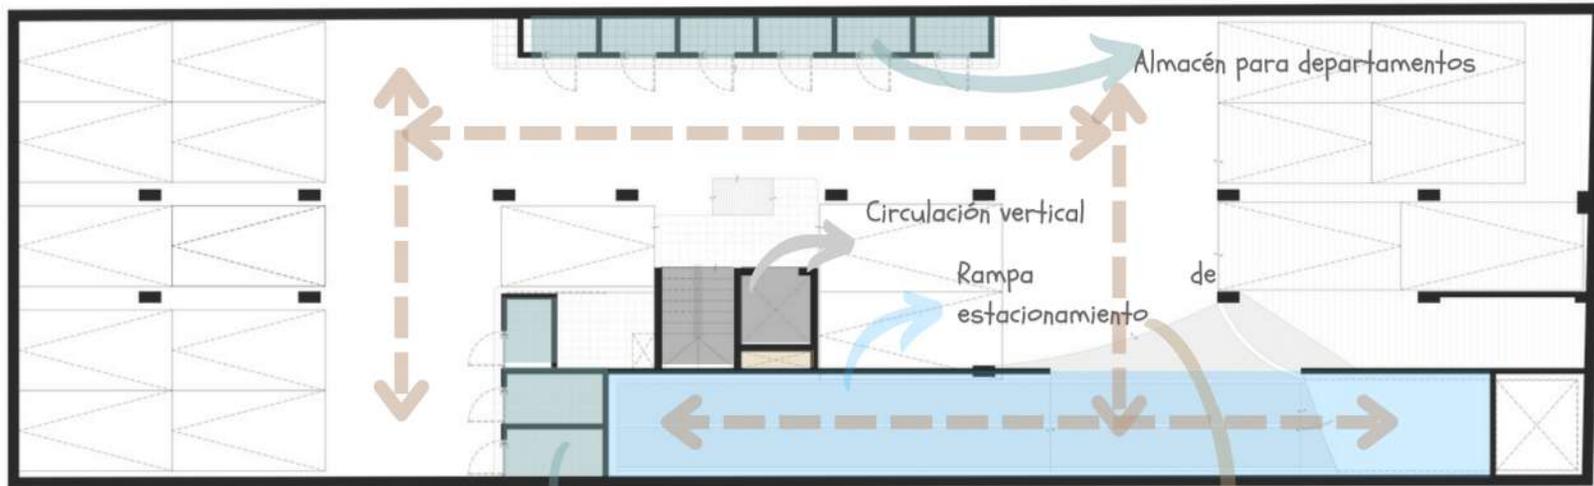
Planos de arquitectónicos. Contexto Arquitectos, 2019
